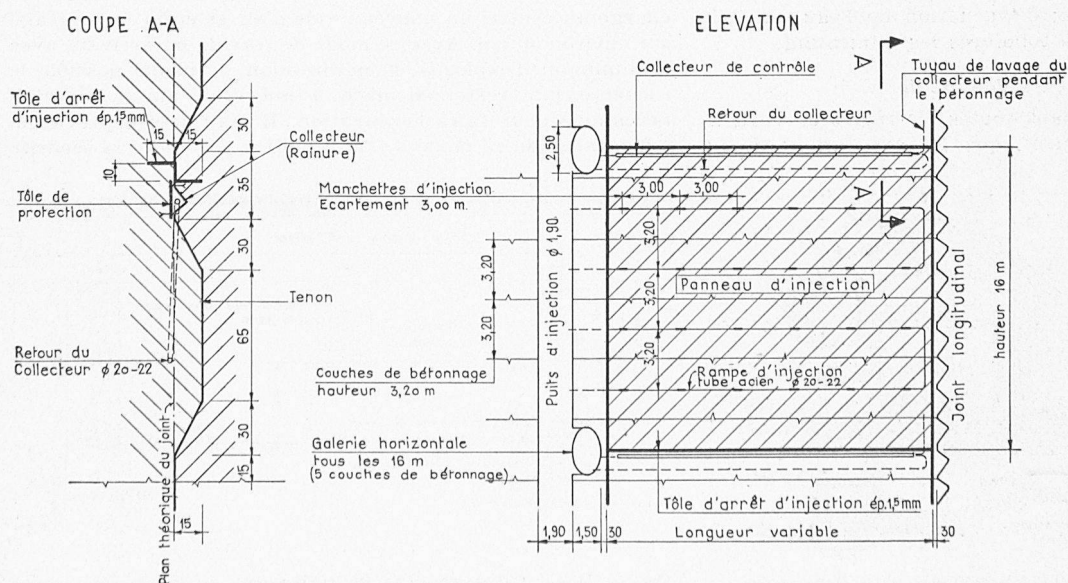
Détails d'un panneau d'injection, élévation 1:400, coupe 1:40.
